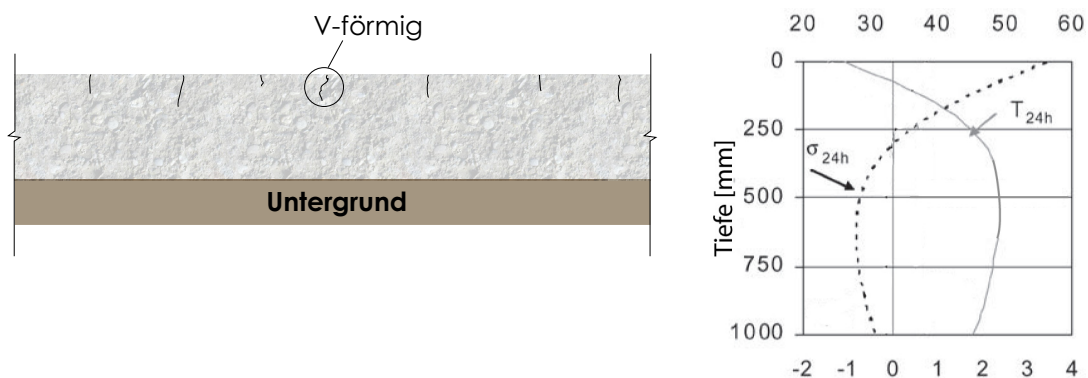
1 m dicke Betonplatte auf einem Untergrund
